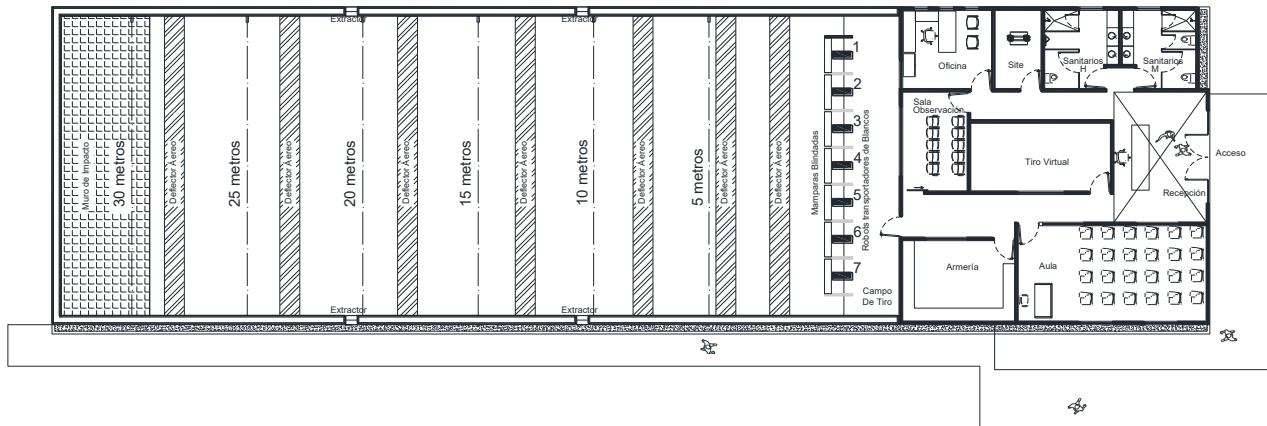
Planta arquitectónica del stand de tiro.
